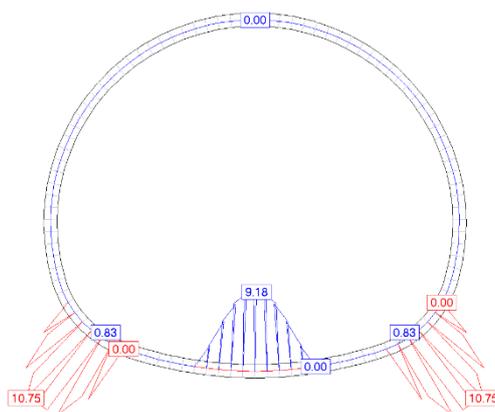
Secção TV.1. Armaduras de cálculo de flexão (cm<sup>2</sup>/m)
